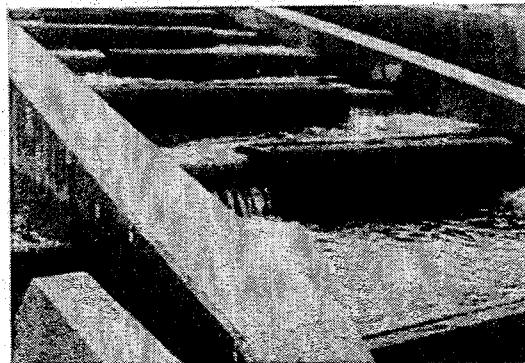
階段式魚道のゴム製耐摩耗板による復旧後の状況
